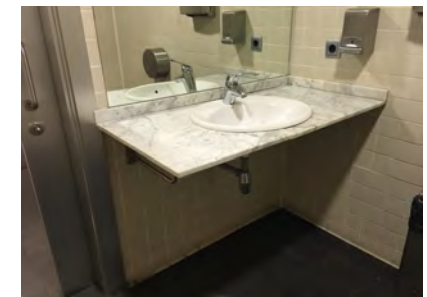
Vista general del lavabo con espacio libre por debajo
